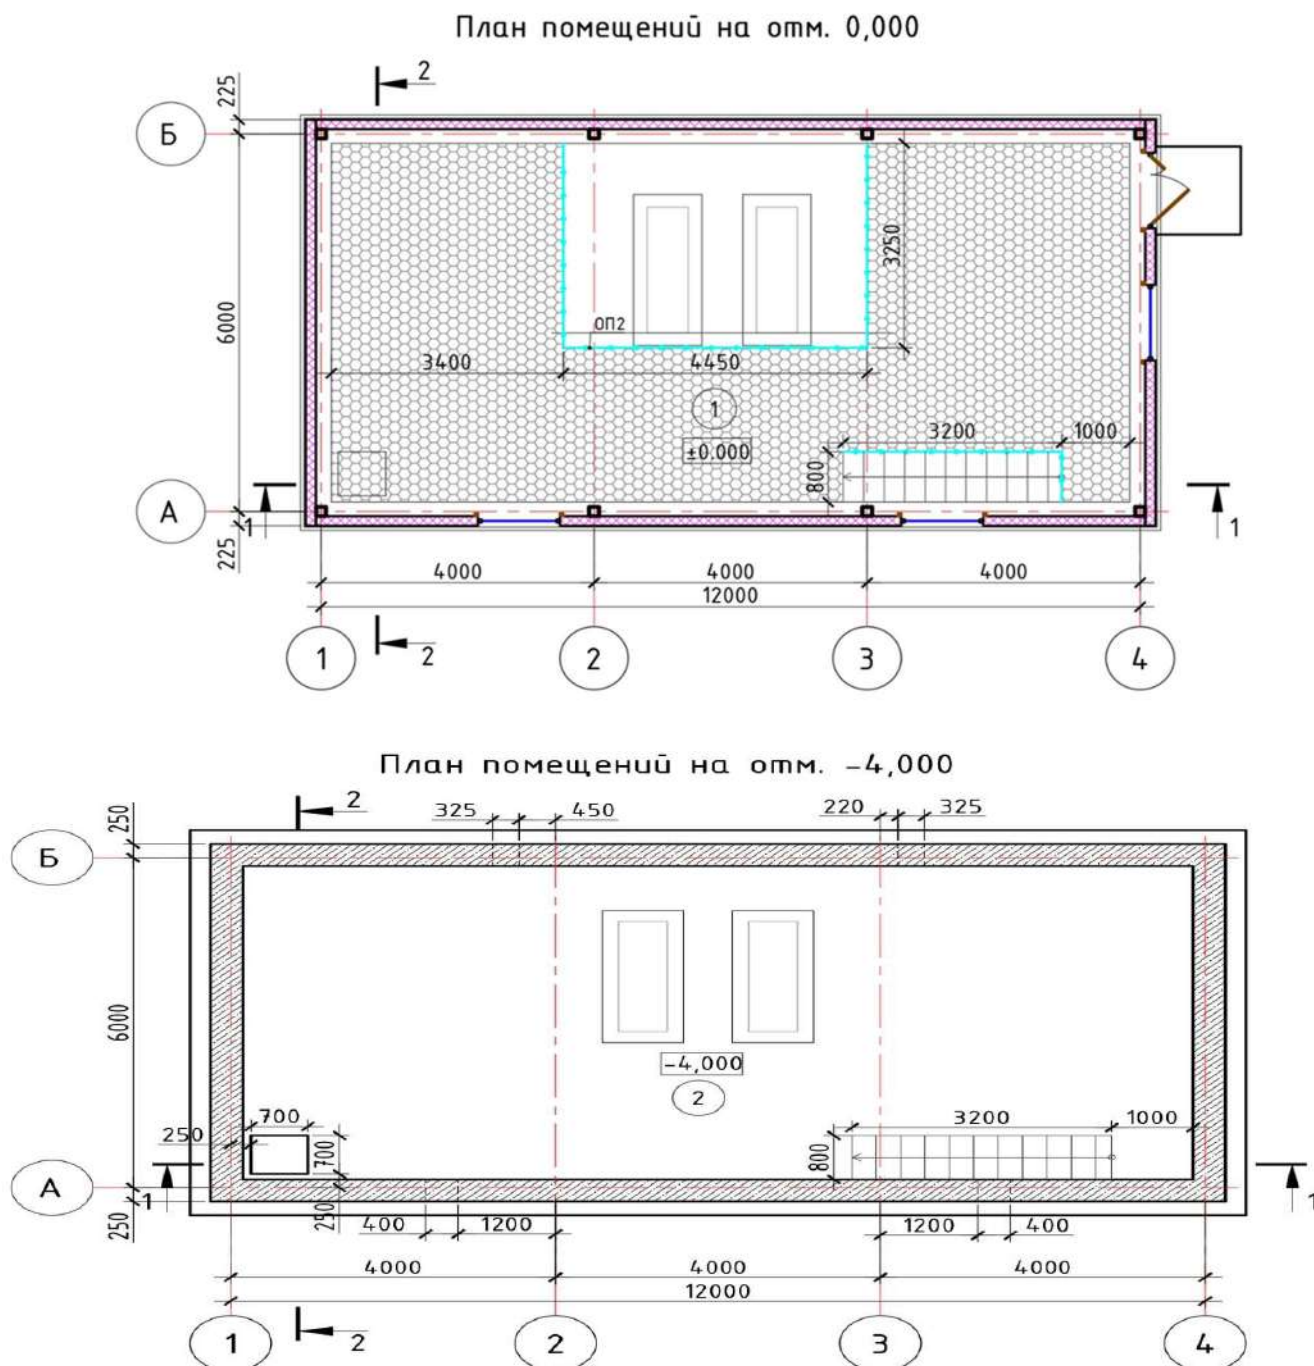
План на отм. -4,000, на отм. 0,000 насосной станции водоснабжения и пожаротушения
